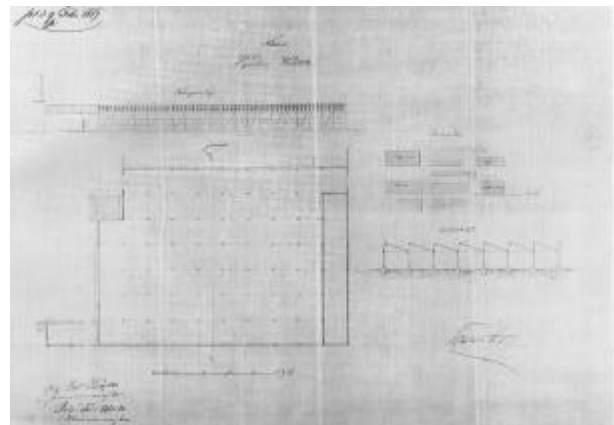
Wagenbauwerkstatt Maschinenfabrik Kramer-Clett, Nürnberg, 1857, Grundriß, Lageplan, Schnitt (aus: Florschütz 2000, 330, Abb. 54)
